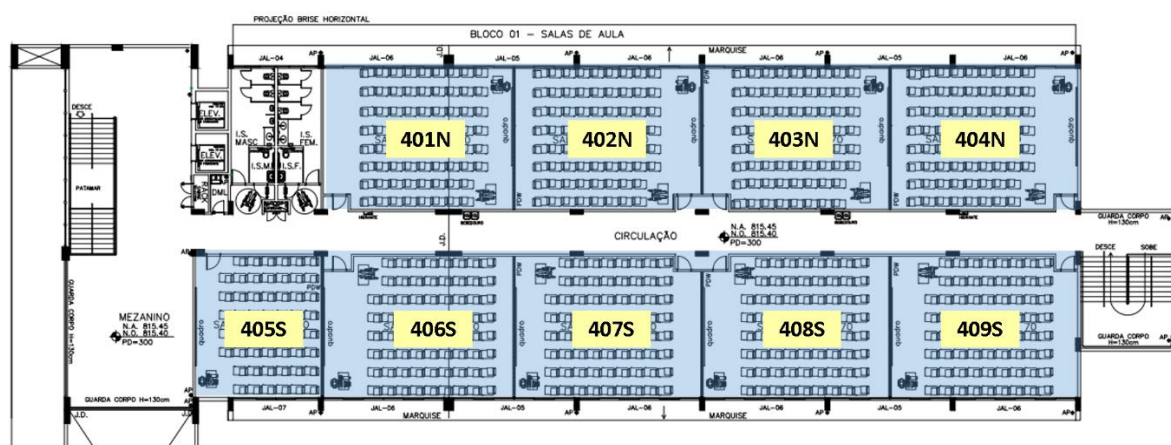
Planta-baixa do pavimento 4 do Bloco 1 do CAD 3
